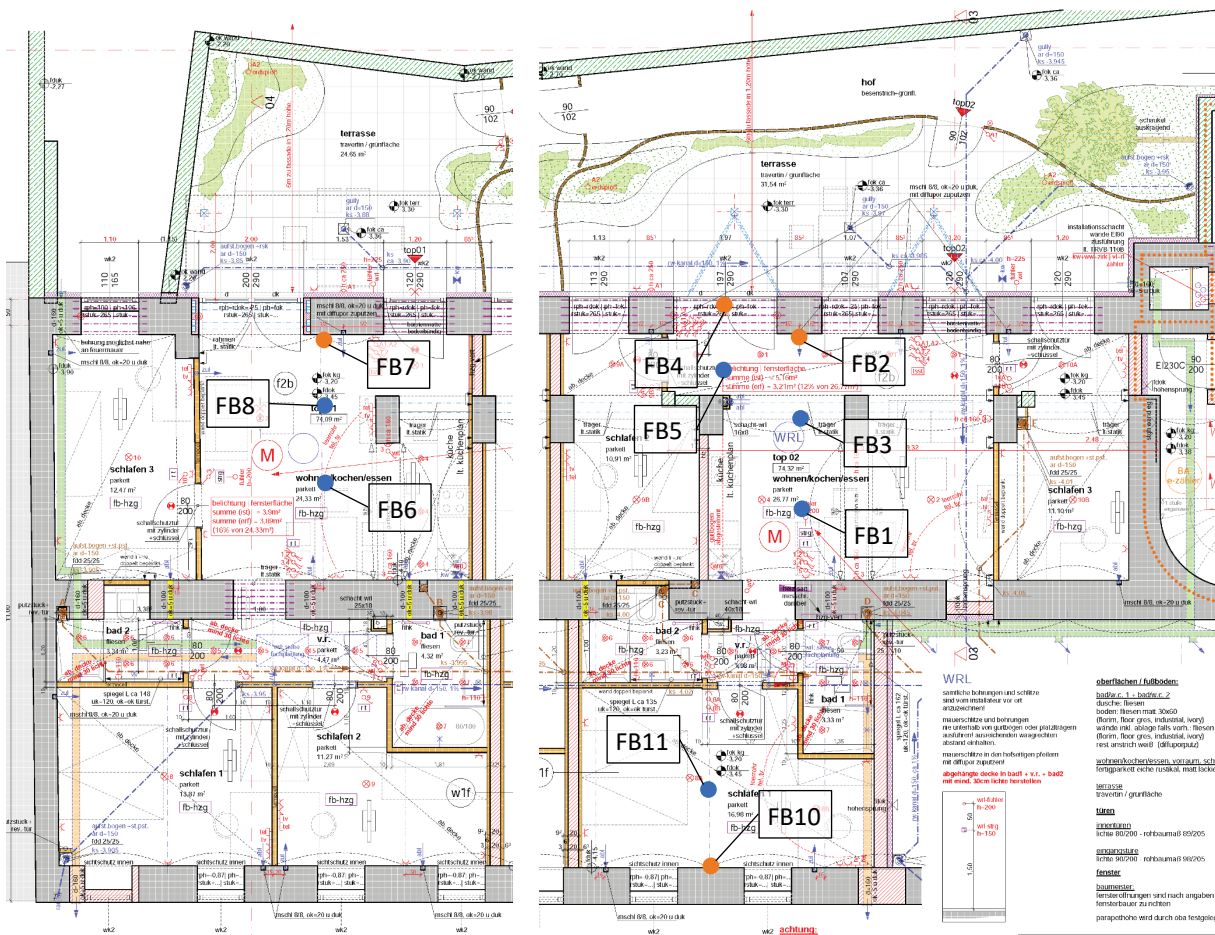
Grundriss der Souterrain-/Gartenwohnungen im Gebäude B mit Markierung der Messpositionen im Fußbodenaufbau; blau markierte Positionen befinden sich im Raum und stellen einen nahezu eindimensionalen Schichtaufbau dar; orange markierte Positionen befinden sich an Boden-Wand-Anschlüssen bzw. an einem Boden-Fensterstock-Anschluss und stellen einen mehrdimensionalen Bauteilaufbau dar;
